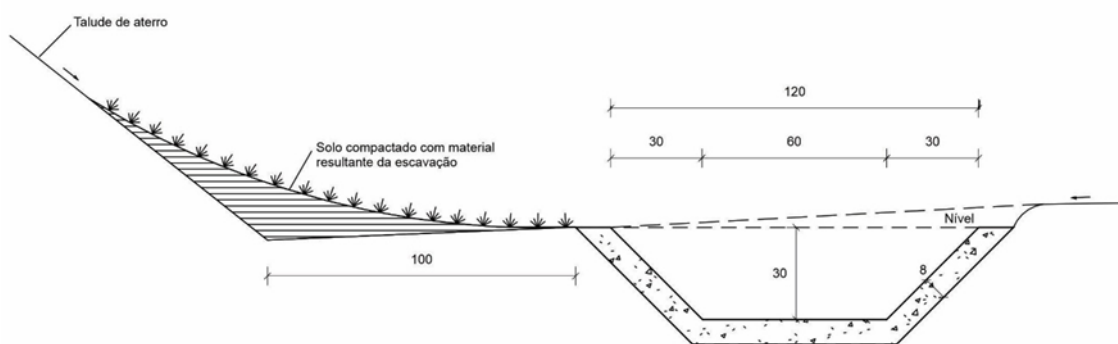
Valeta de Proteção de Aterro em Concreto - VPAC 160-30.
